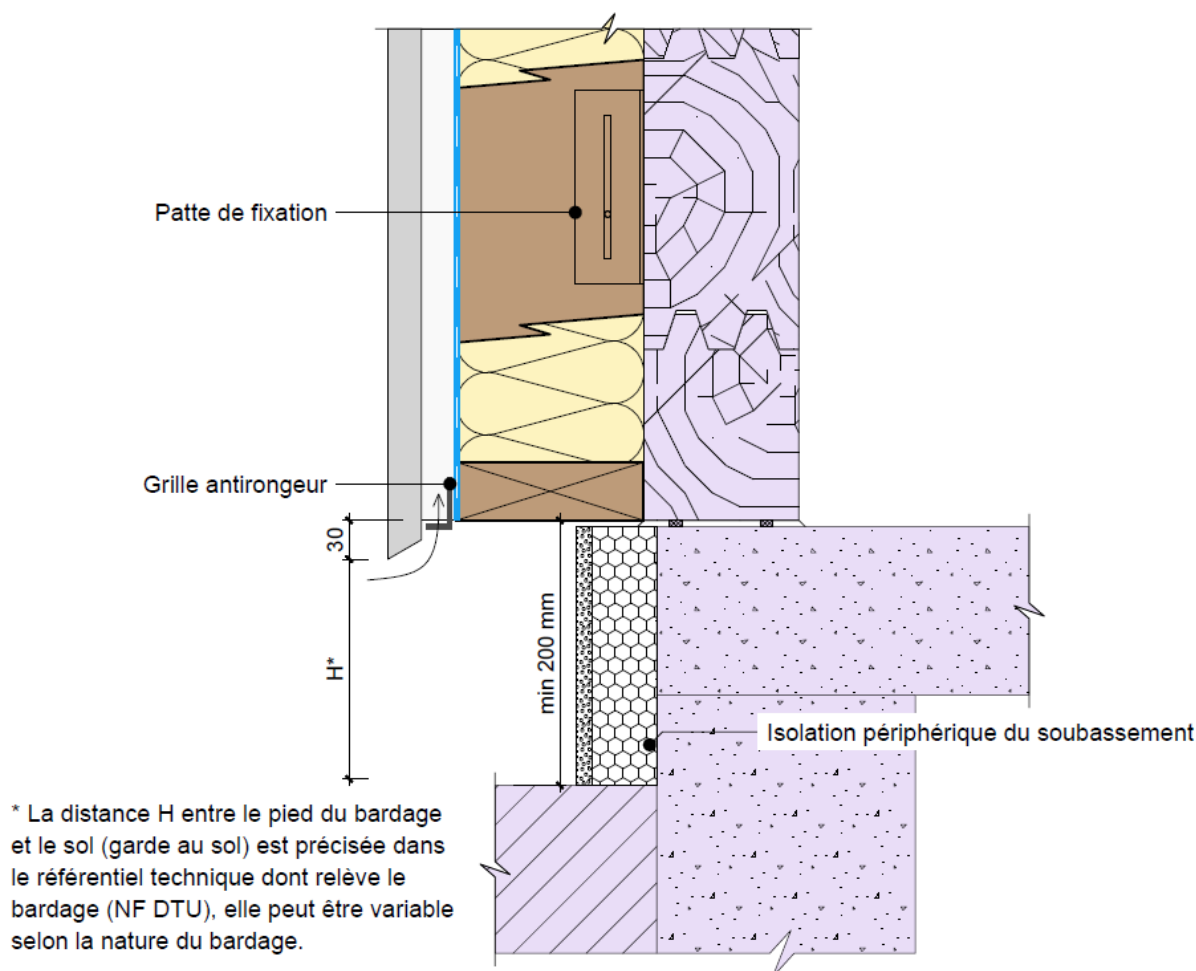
Pied de mur – FOB fondée en pied (coupe verticale)
